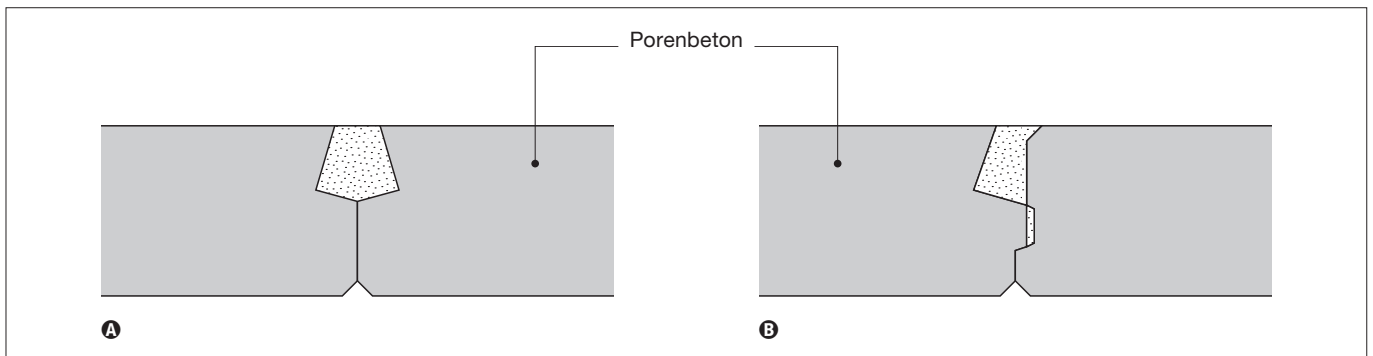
Beispiele für Mörtelfugen in Tragwerken aus Decken- oder Dachbauteilen bis zur Klasse E 120 nach prEN 12602:2007-02
